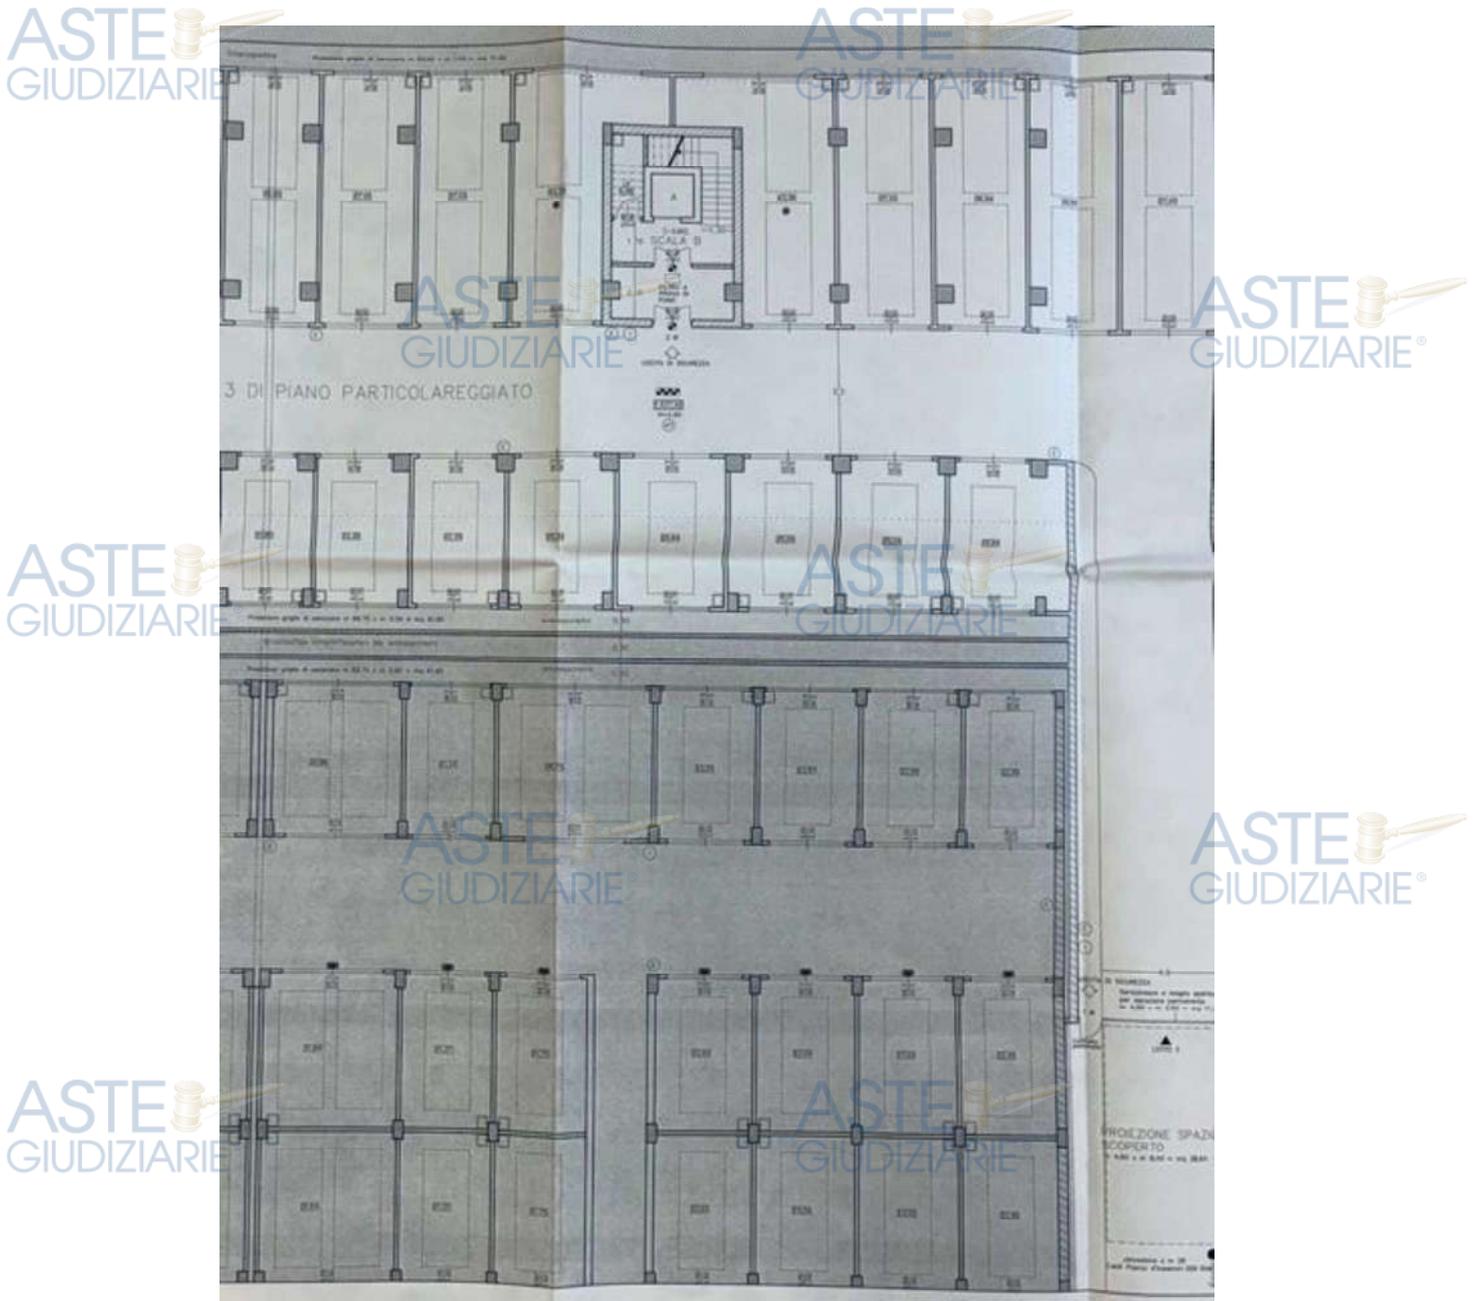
Planimetria presente all'interno del permesso di costruire. La planimetria coincide con quella catastale e con lo stato di fatto.
